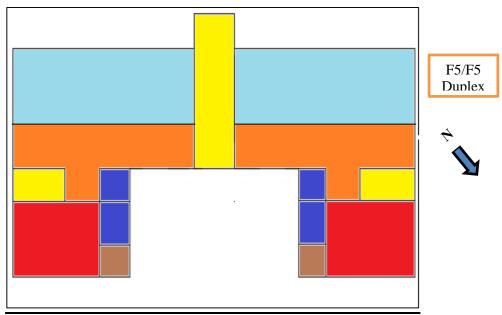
type 2 plan 1er étage F5duplex / F5duplex
